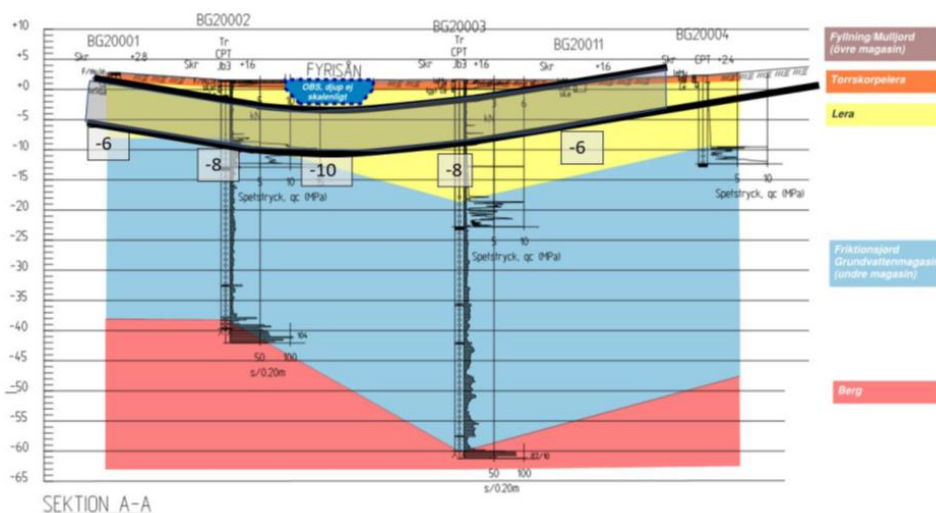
Placering av tunnel, tråg och utrymnings-schakt för alternativ TUB.
